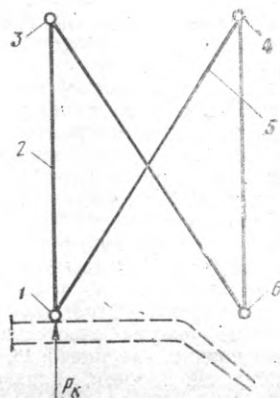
Расположение струн на воздушной стрелке: 1, 6 — контактные провода; 2 — вертикальная струна; 3, 4 — несущие тросы; 5 — перекрестная струна
